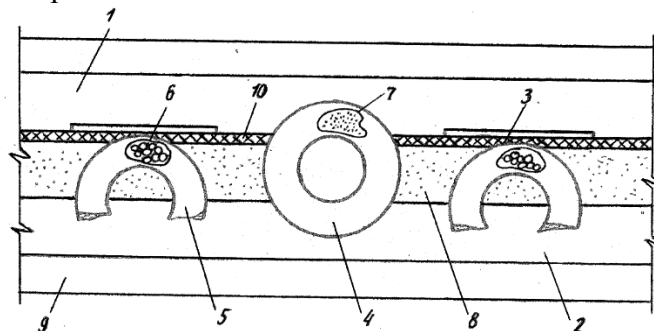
Сейсмостойкий фундамент, продольный разрез (а.с. СССР №1760020)
